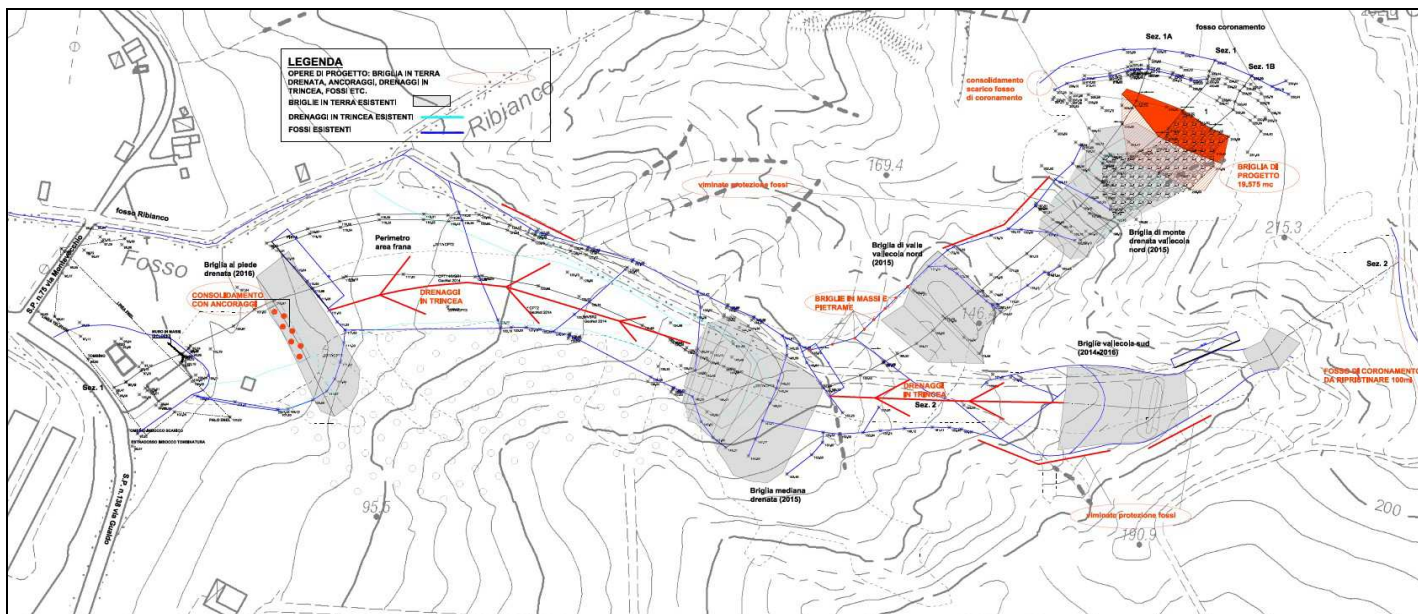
Planimetria dell’area con individuazione delle opere di consolidamento realizzate
